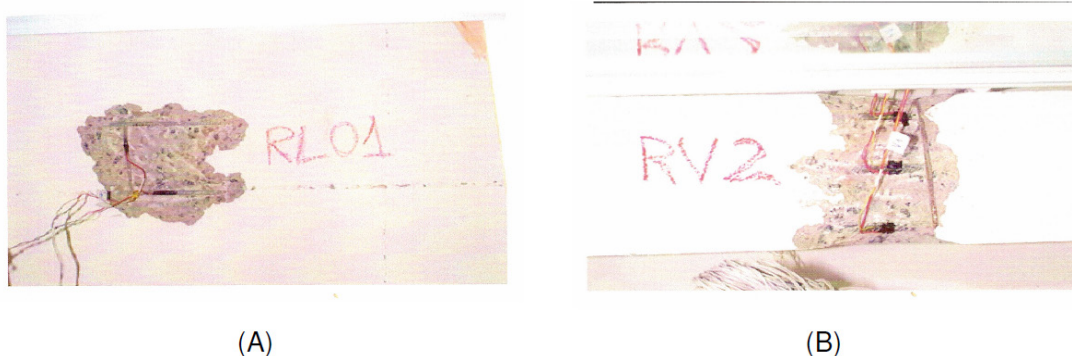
(A) Instrumentação da laje 01 (deformação nas armaduras longitudinal e transversal). (B) Instrumentação da viga V2 (deformação nas armaduras longitudinais)
